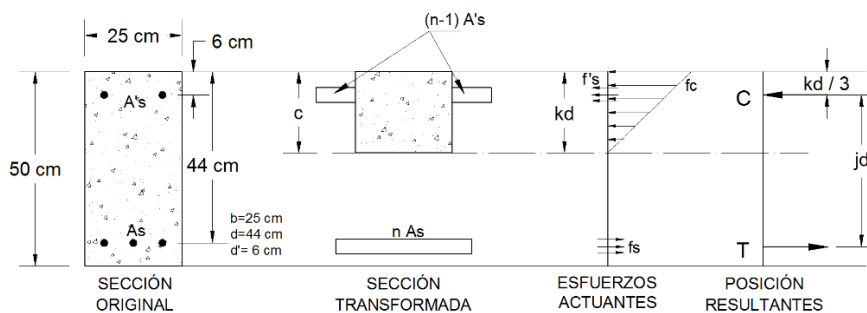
Planteamiento para deducir el eje neutro en una sección fisurada
